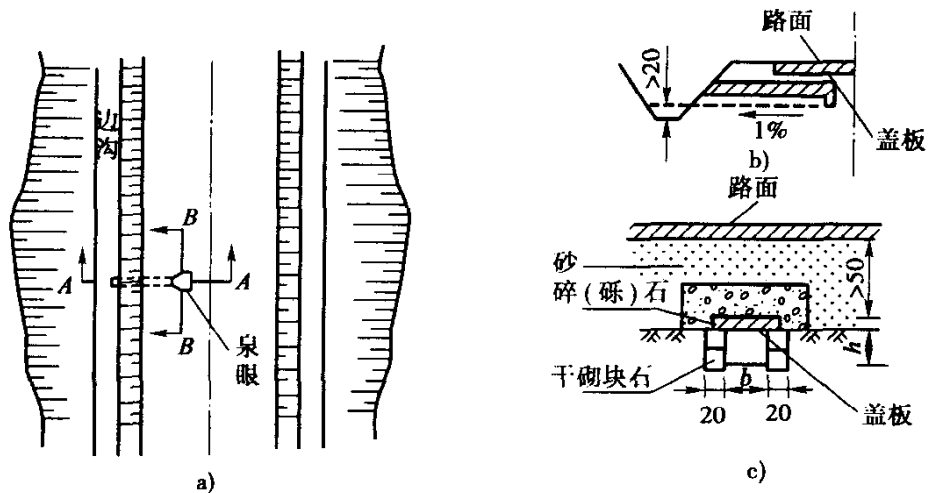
暗沟布置及构造 (尺寸单位:cm)
